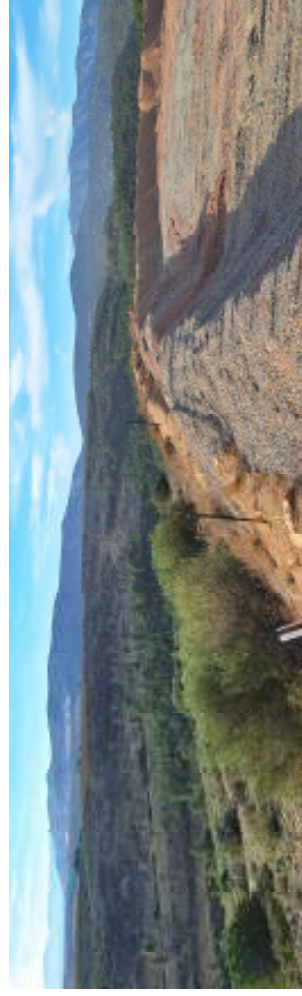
Remblaiement zone sud trop artificiel et minéral
